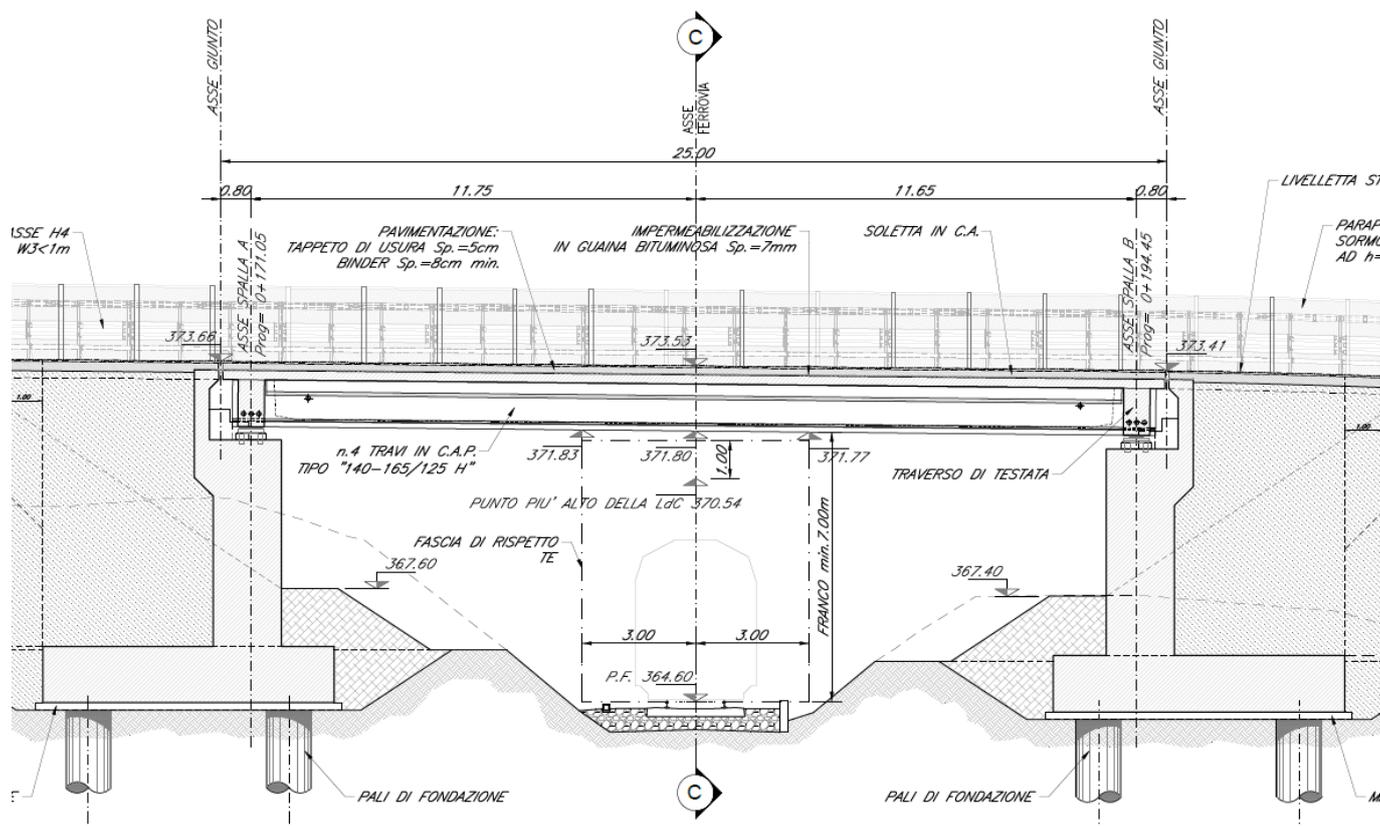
Sezione longitudinale cavalferrovia con fascia di rispetto TE
